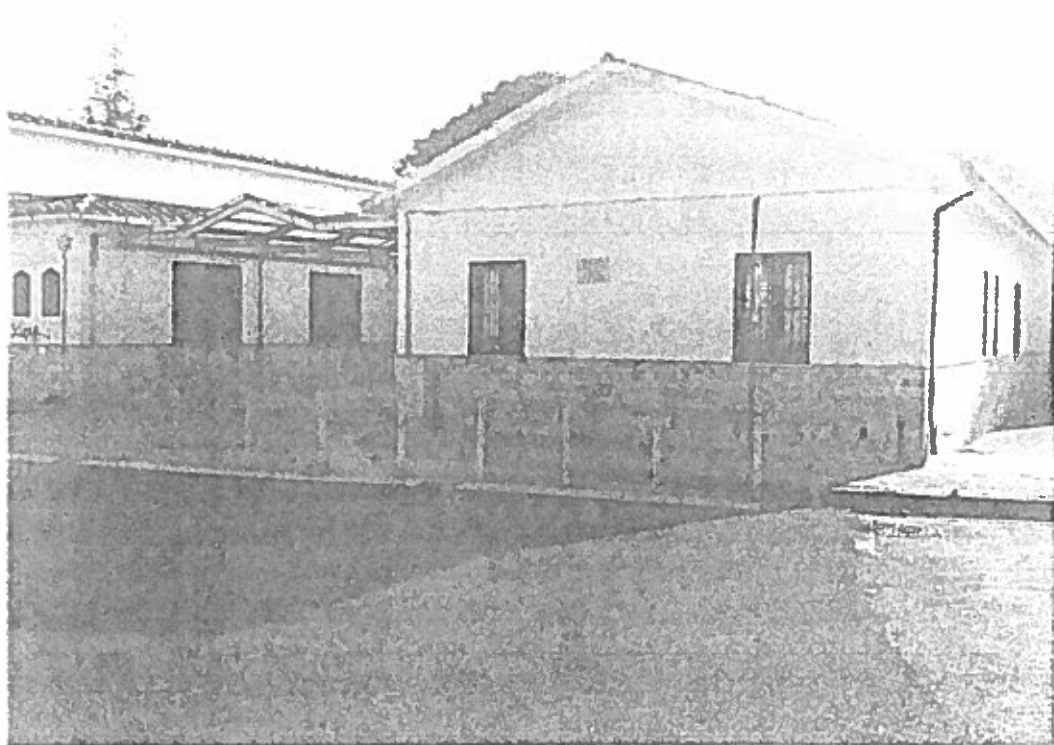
VISTA EST ZONA INGRESSO "C"
